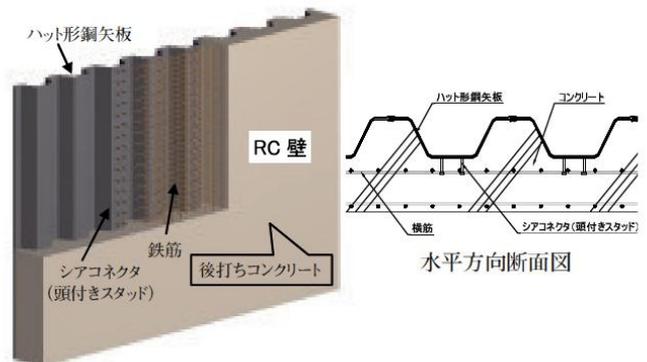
鋼矢板合成地下壁（J-WALL工法）の概略図
